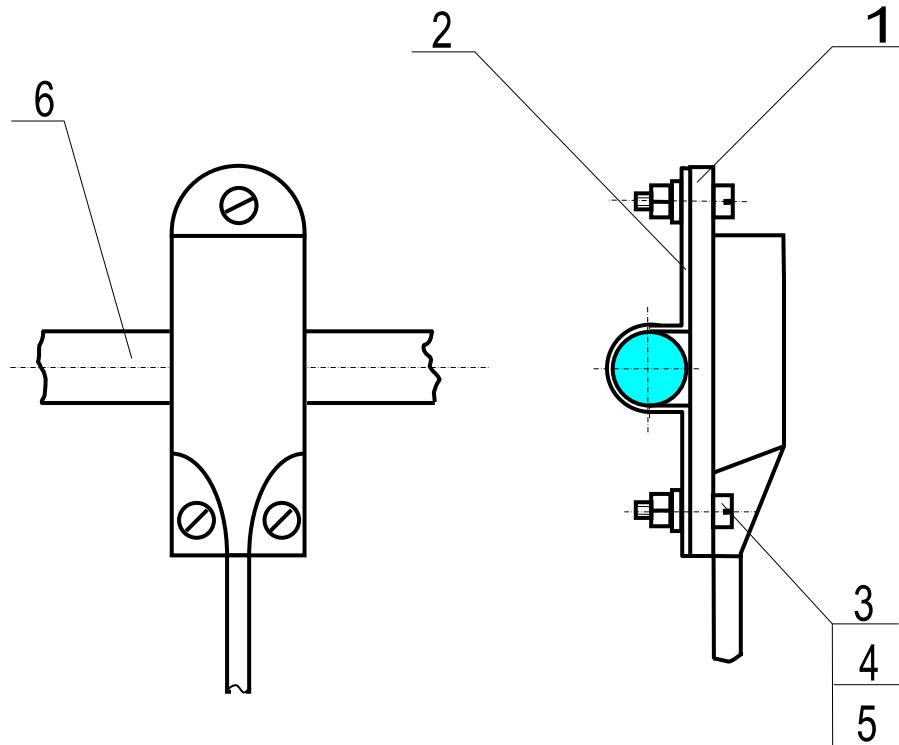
Установка ВП на плоской металлической конструкции
